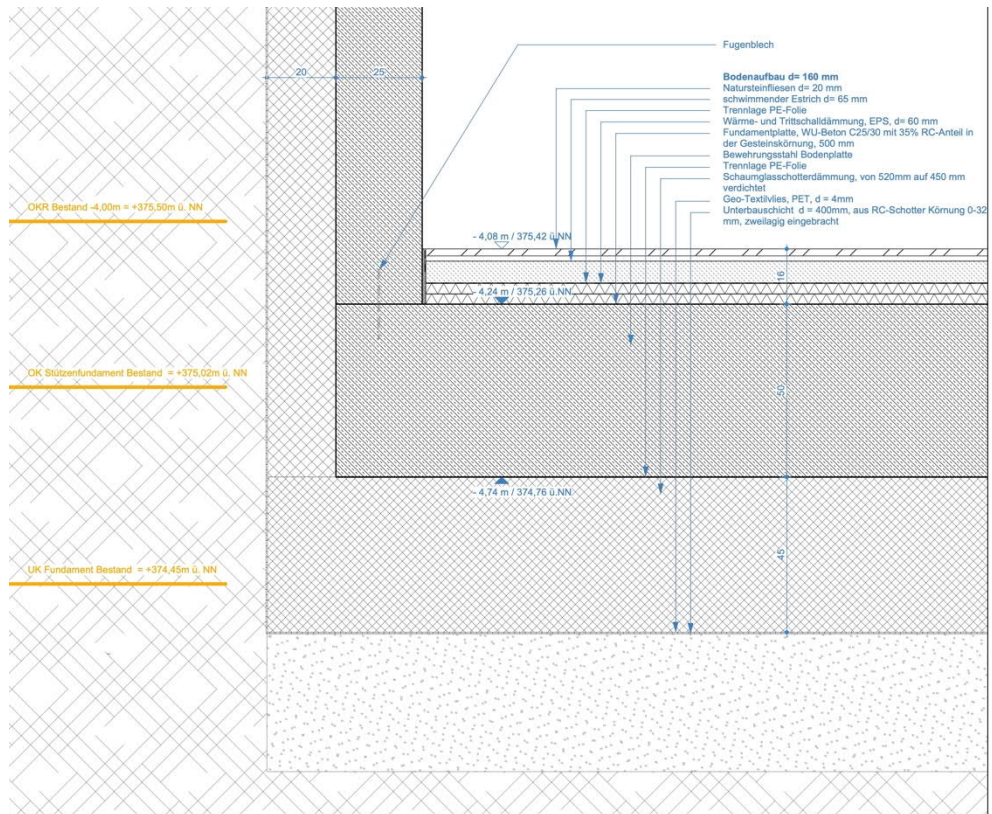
Detail Gründung/Bodenplatte_umgesetzte Konstruktion
